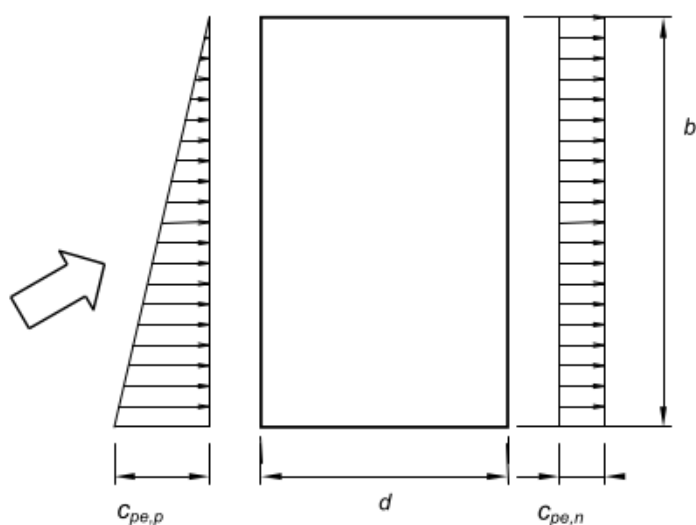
Azioni torcenti su edifici a pianta rettangolare (vista in pianta).
